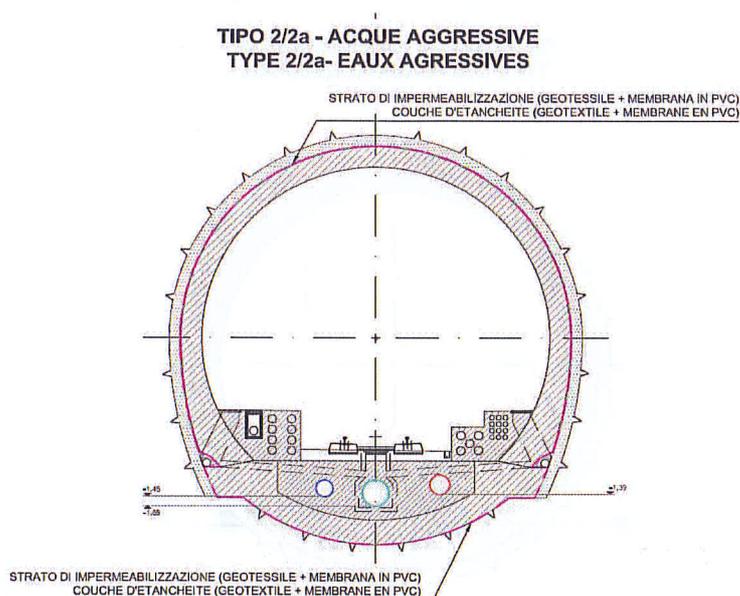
Impermeabilizzazione di tipo 2/2a per scavo tradizionale
